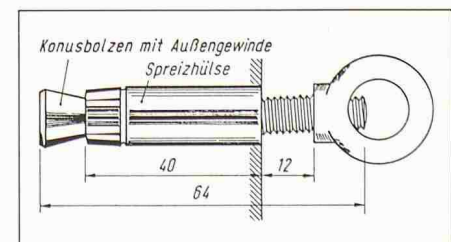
Edelstahlanker zum Verdübeln einer Sanierungsschicht aus Stahlfaserspritzbeton
